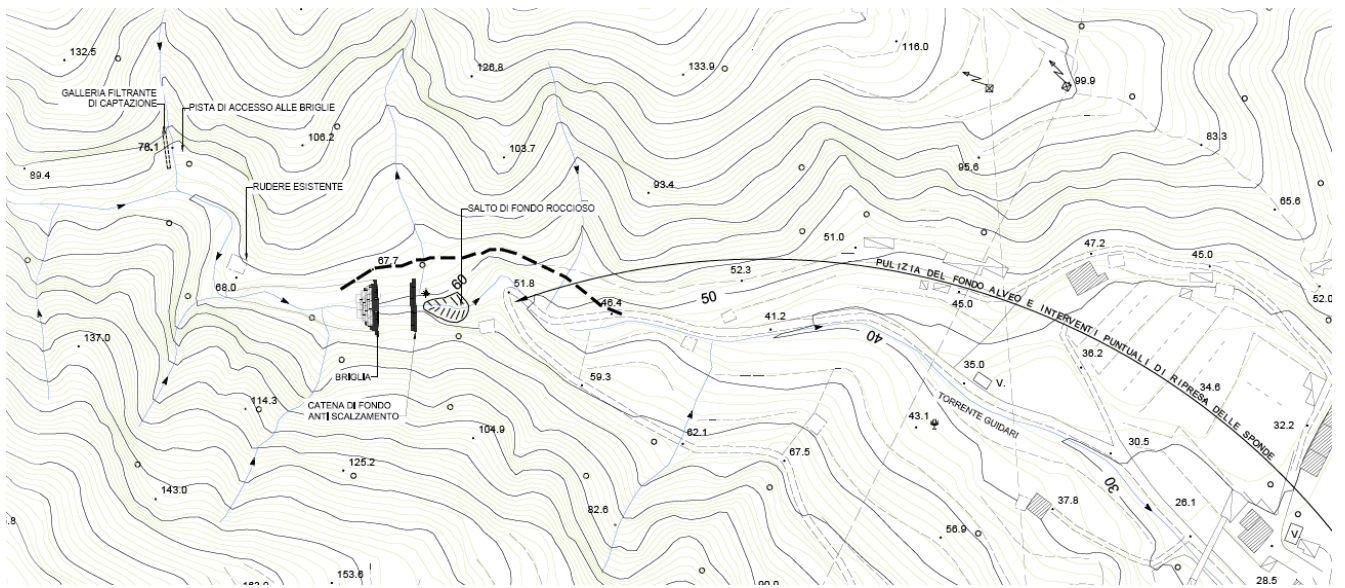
Estratto della planimetria di progetto con l'ubicazione della briglia di sistemazione dell'asta.
